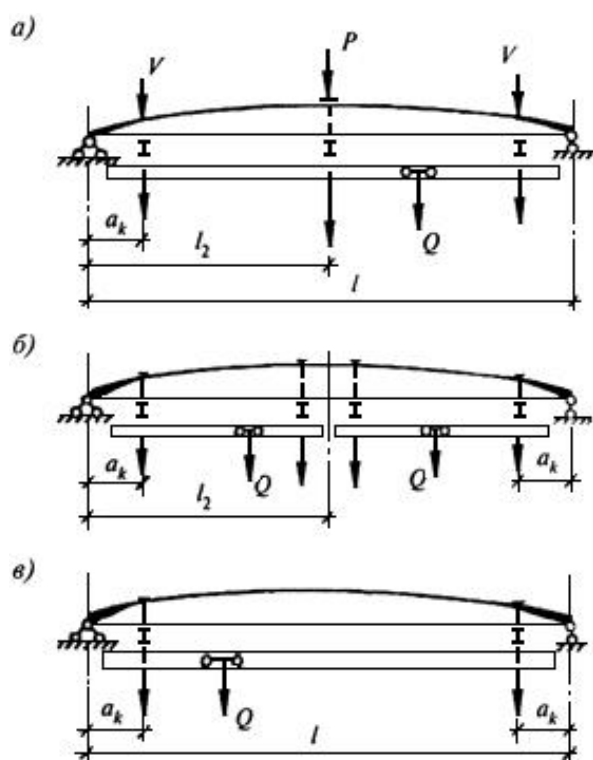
Типовые схемы нагружения (а, б, в) покрытия из панелей-оболочек КЖС подвесными кранами
